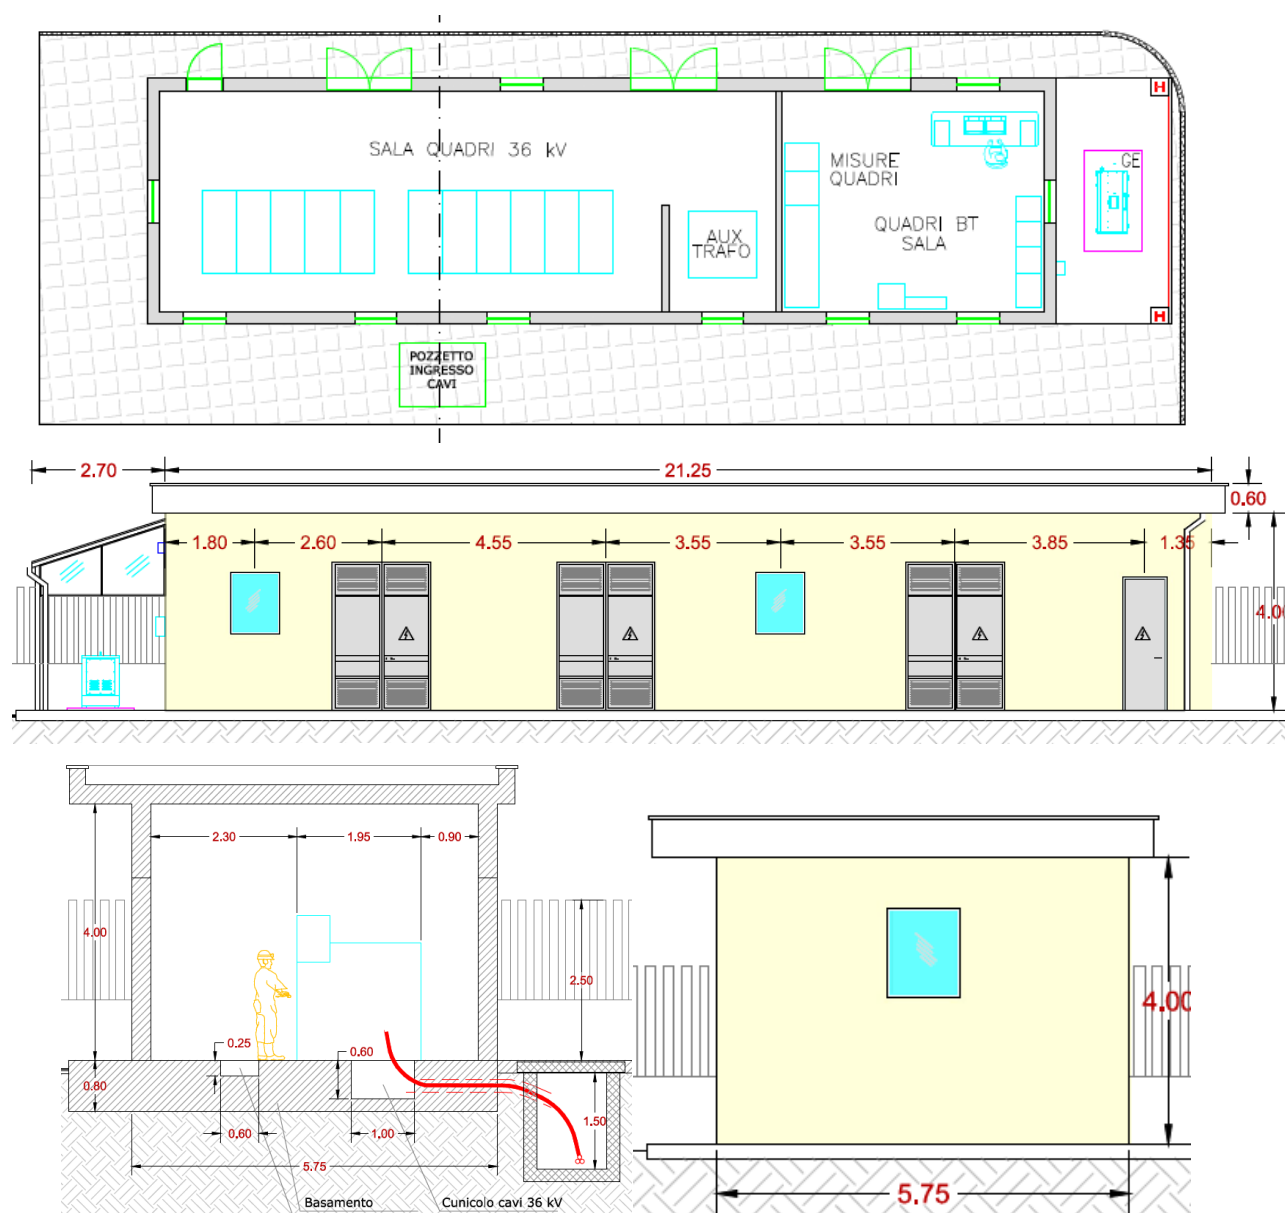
viste edificio di comando – planimetria, prospetti, sezione
